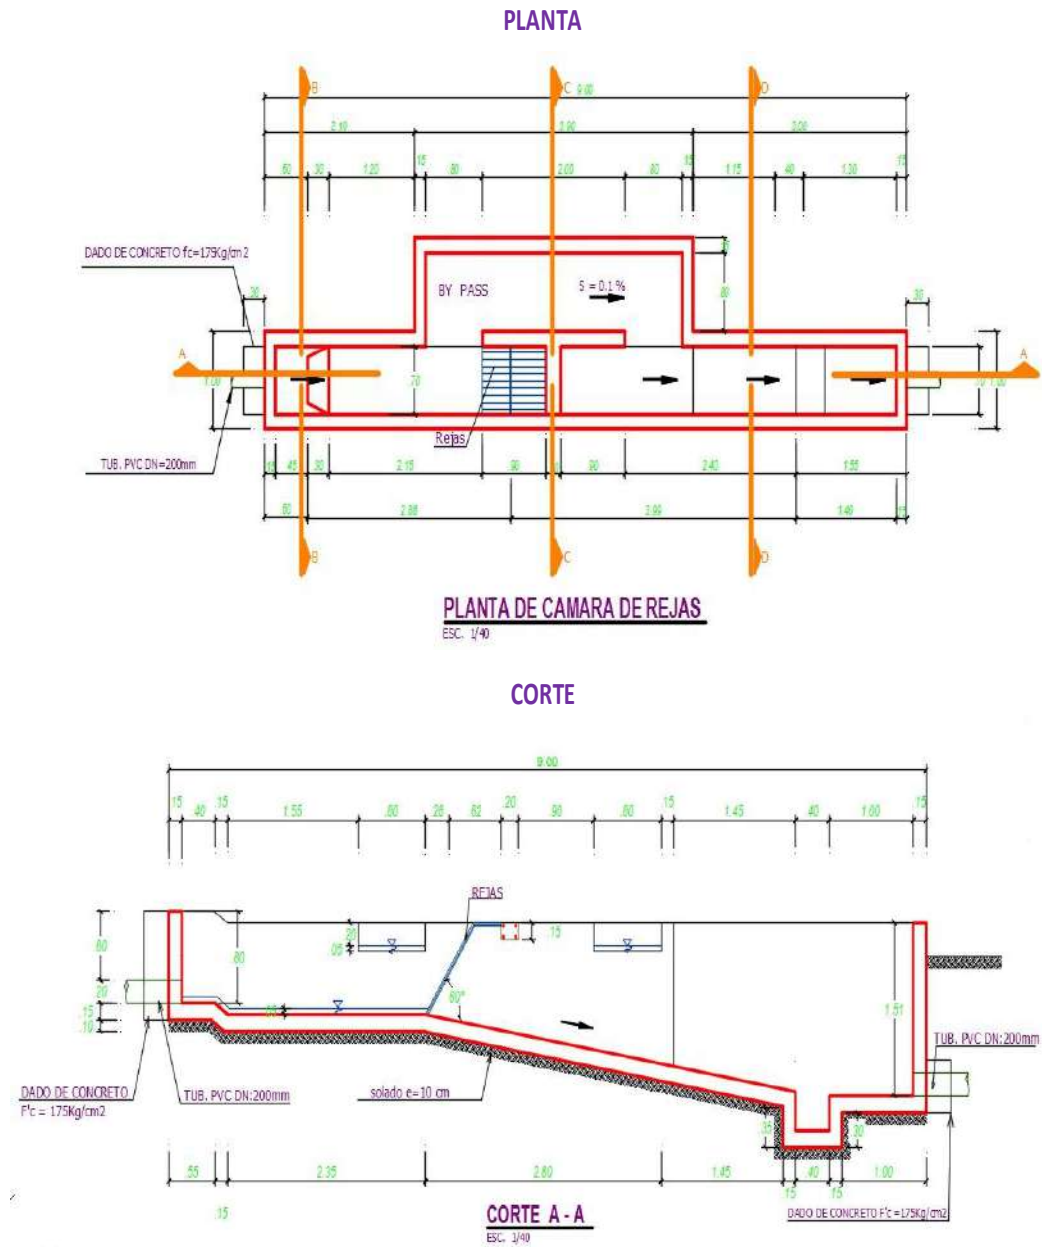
Planta y Corte de Desarenador y Cámara de Rejas
